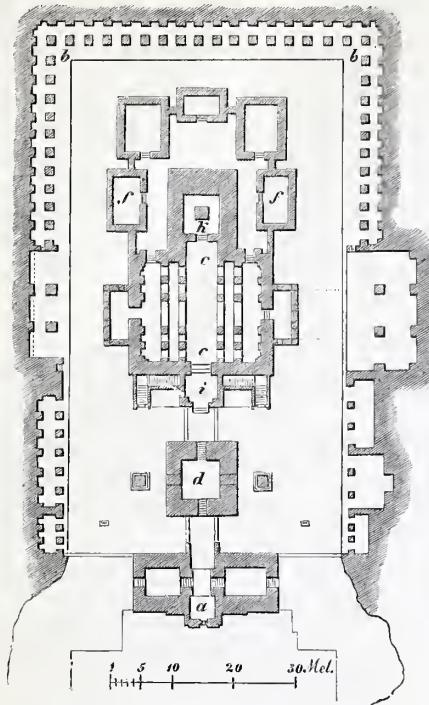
Grundriss der Kailas zu Ellora.
